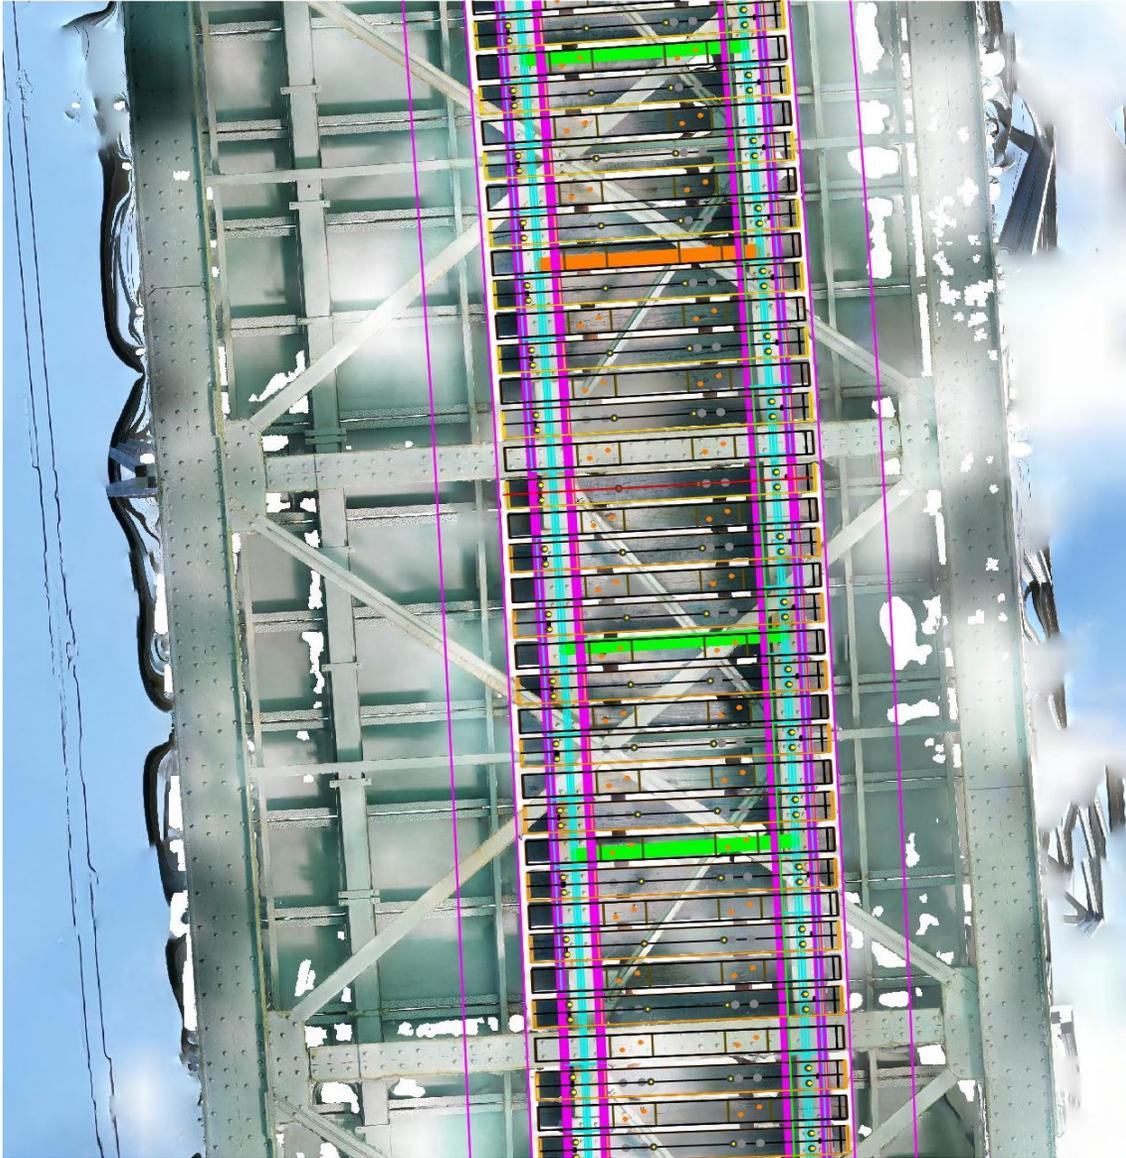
Modell der Brücke mit dem Orthofoto der Intel Falcon 8+ im Hintergrund.
